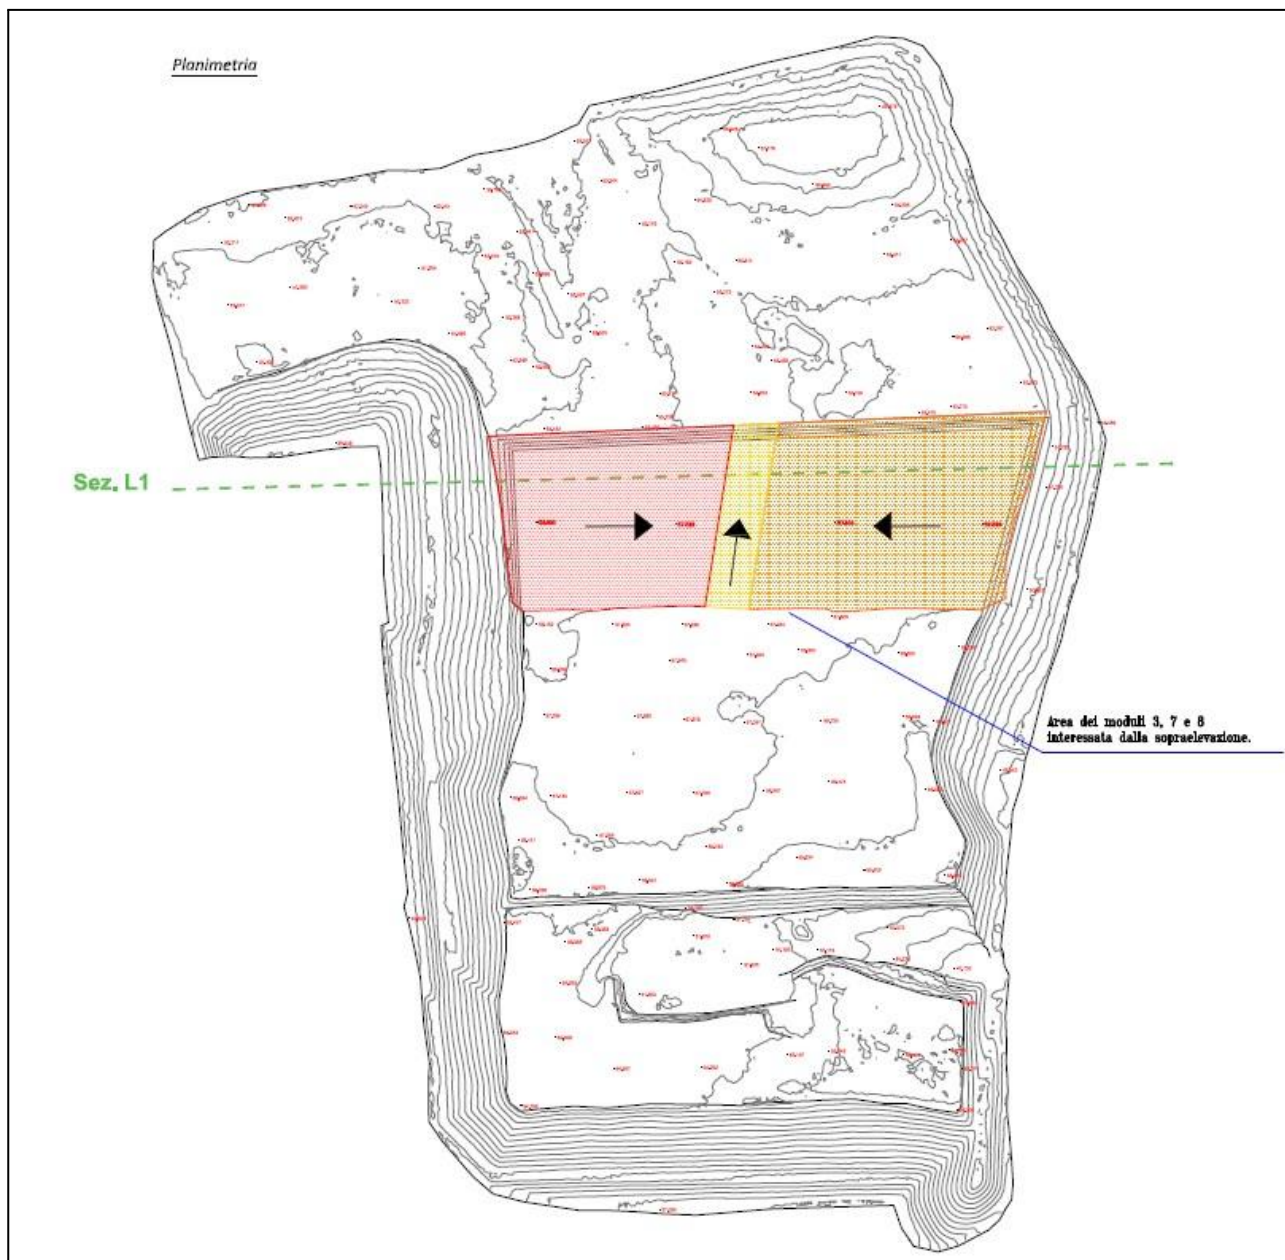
Planimetria aree sopraelevazione sui moduli 3, 7 e 8
